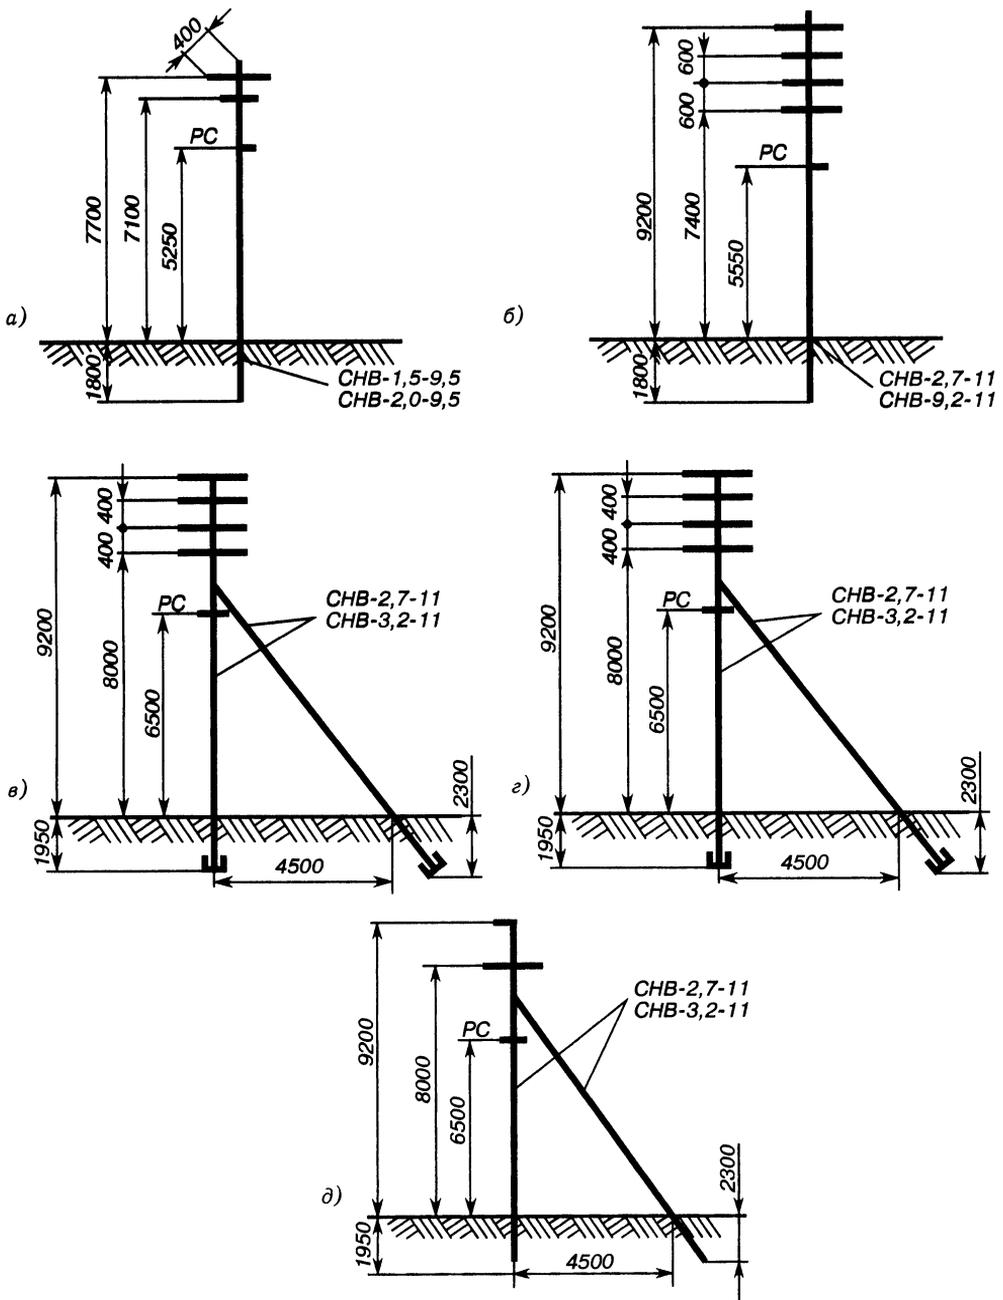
Схемы железобетонных опор ВЛ 0,4 кВ по типовому проекту 3.407-122.
